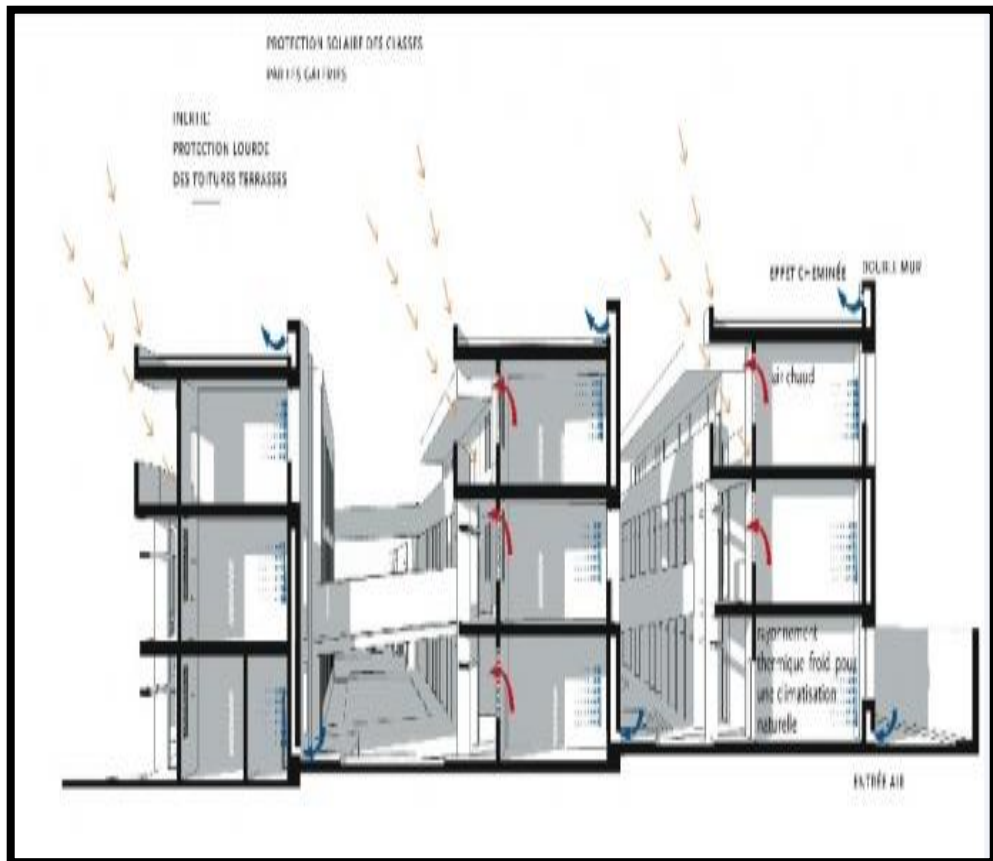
coupe transversale des salle de classe présente la ventilation naturelle
